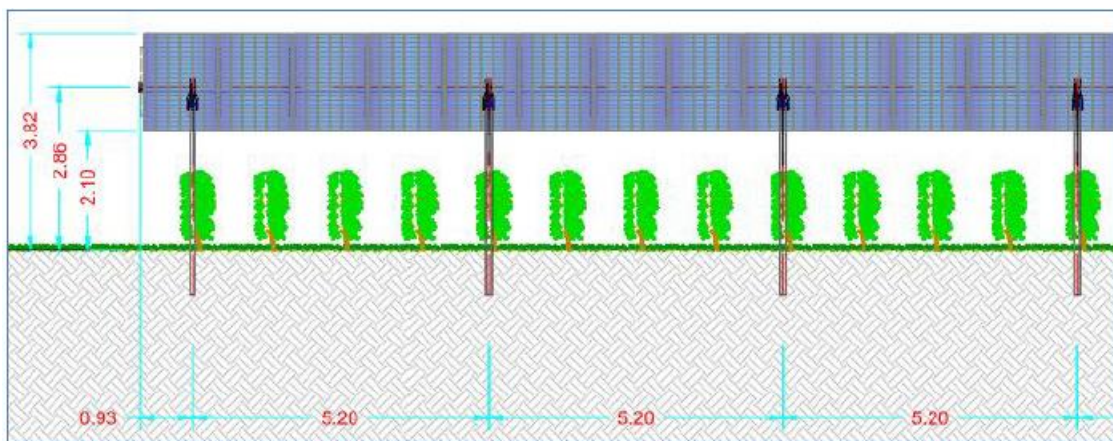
Sezione longitudinale tipologica struttura Tracker con vigneto
